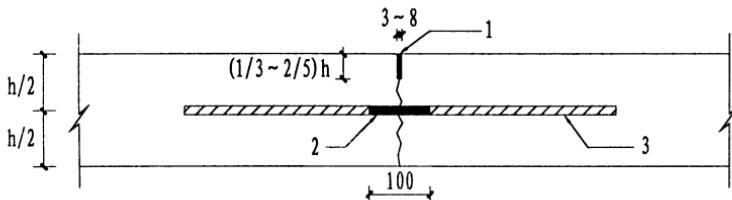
纵向缩缝构造(尺寸单位:mm)
